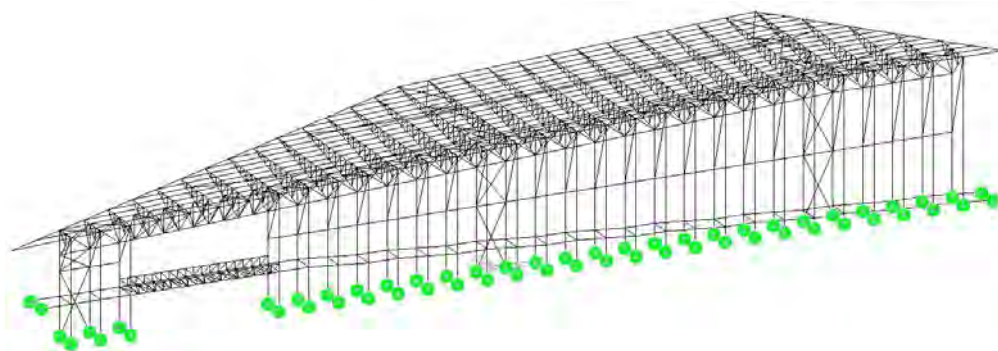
Vincoli esterni ad incastro applicati alla base dei pilastri.
